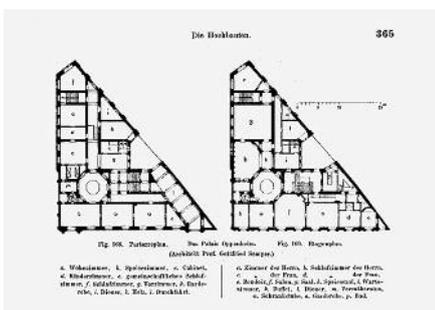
Grundriss EG und OG nach Plänen von G. Semper. (Sammlung Dr. Heidrun Laudel)
